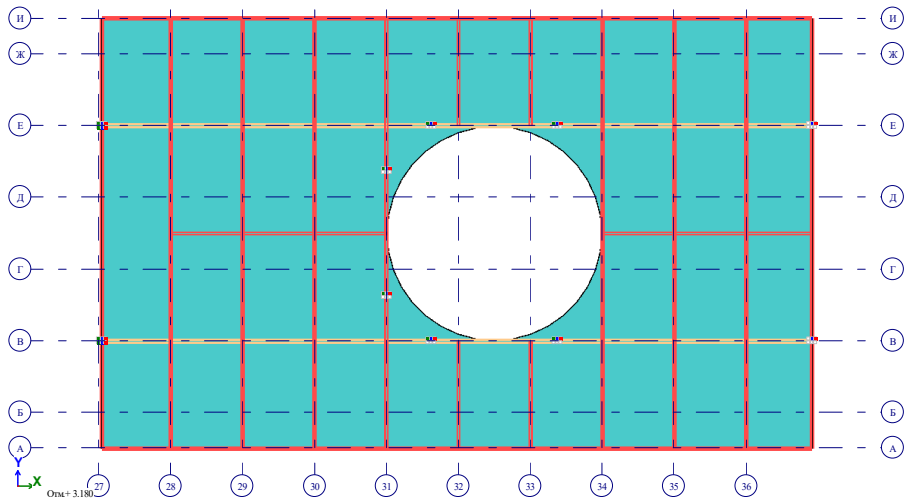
Первый вариант усовершенствованной схемы. Расчетная схема
